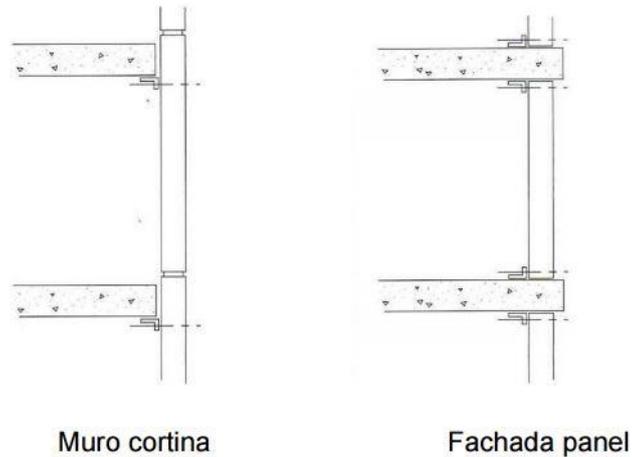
J.LL. ZAMORA & J.M. CALDERÓN Diseño de fachadas ligeras. Manual de introducción al proyecto arquitectónico (Recuperado 26 Marzo 2015)
